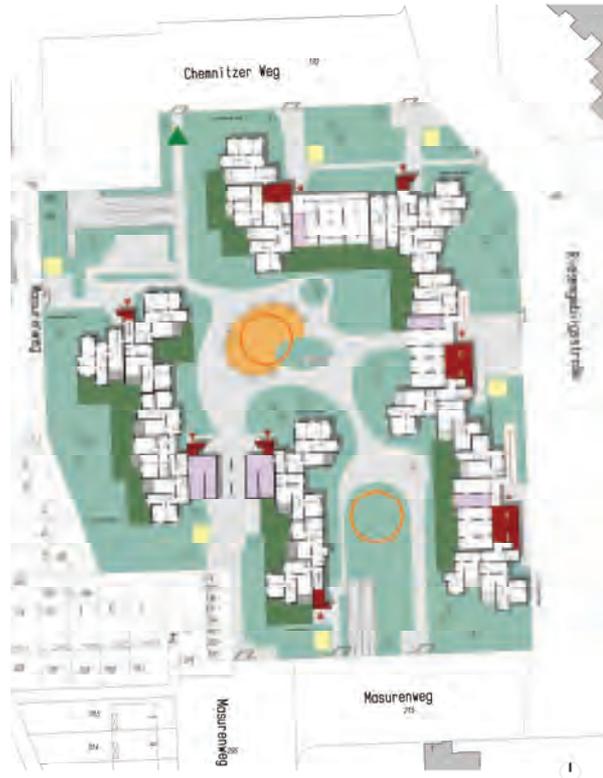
Grundriss Erdgeschoss Entwurf
